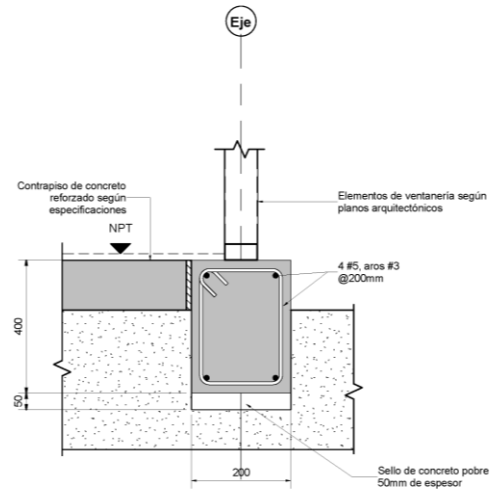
Detalle de viga de fundación - Elaboración propia, 2024
